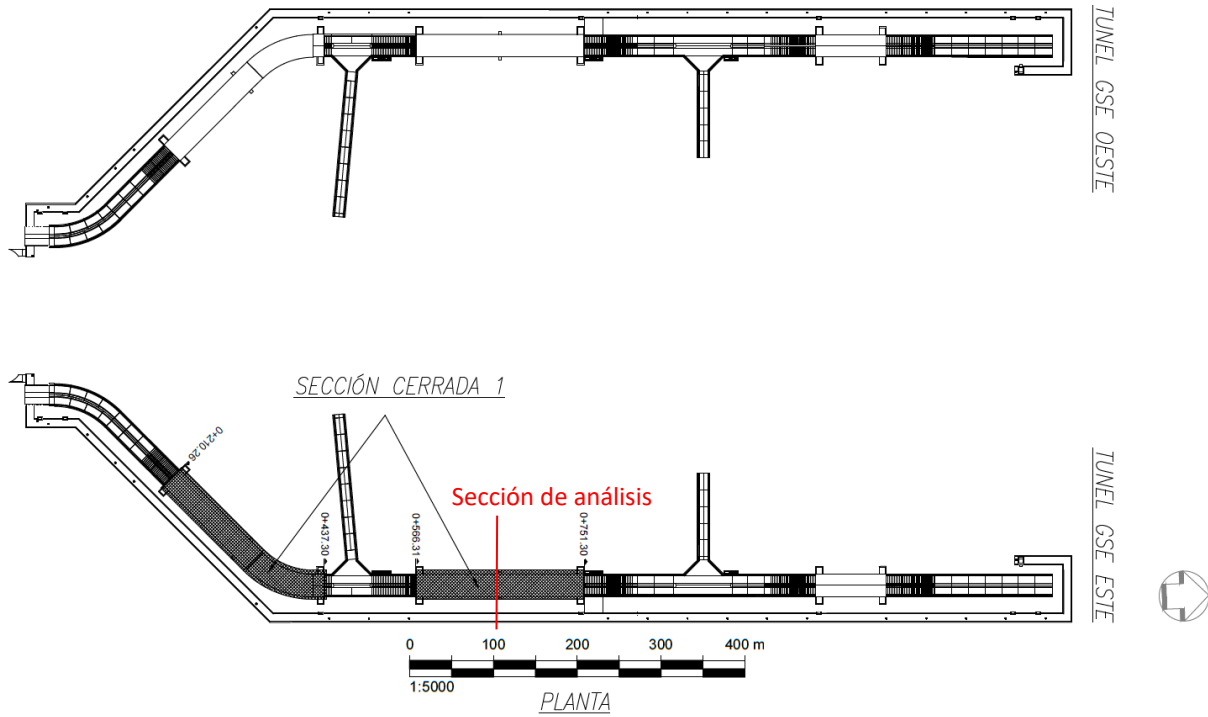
Planta general con localización de las zonas cerradas del túnel GSE Este (II UNAM, 2016)
